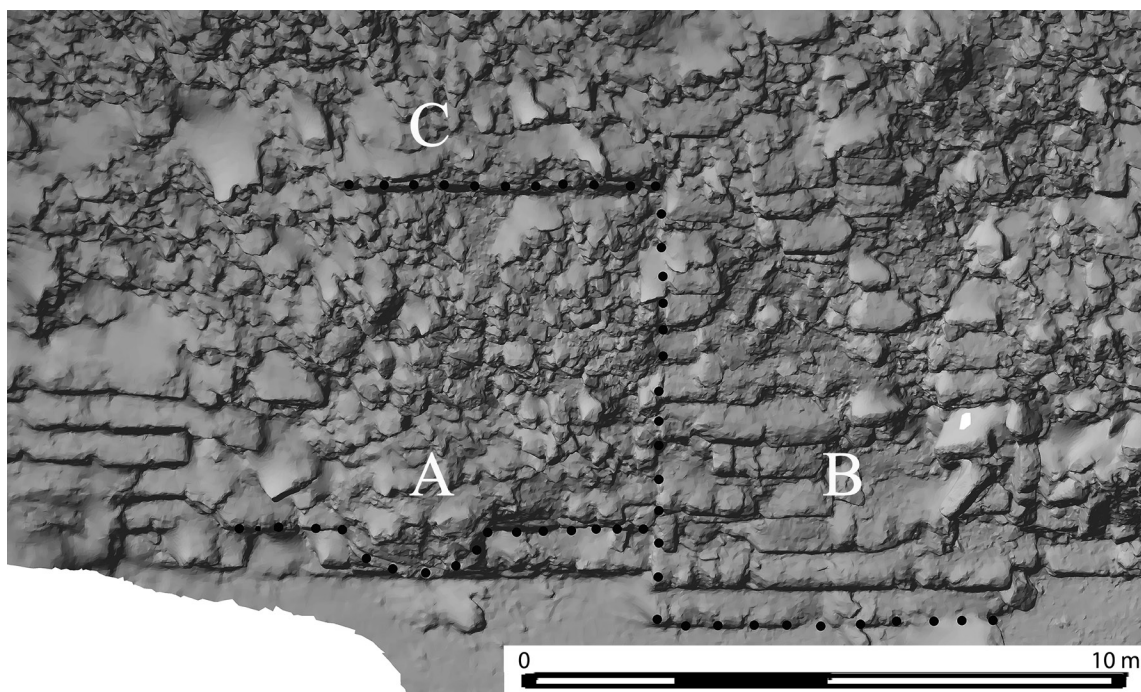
Ortofoto de elevación frontal y de planta en los que se resaltan detalles arquitectónicos de importancia para las intervenciones de restauración y la comprensión del edificio. Ortofoto: J. Marín, J. Guzmán© FARES.
